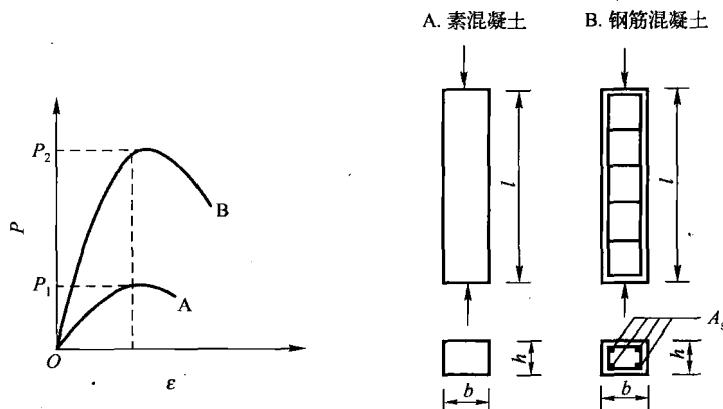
素混凝土和钢筋混凝土轴心受压构件的受力性能比较
